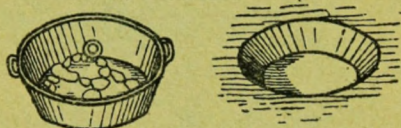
Производство съемной крышки в железобетонном септике. Таз для варенья служит опалубкой для отверстия (справа), а внутренняя часть таза (слева) — для крышки.
